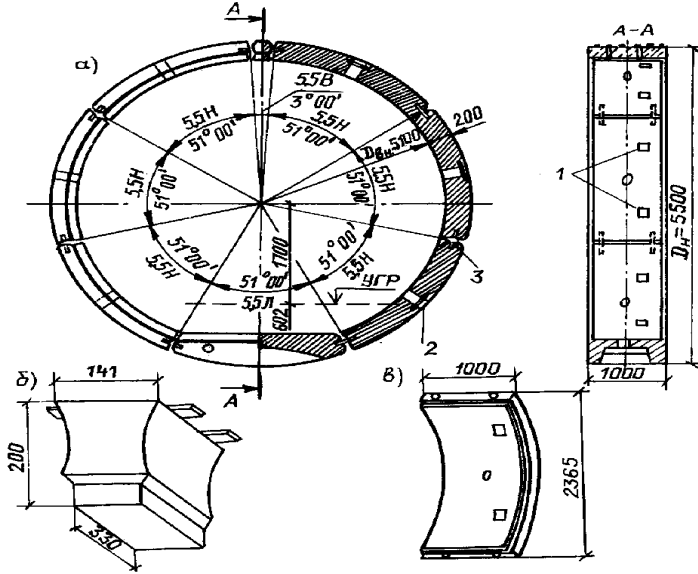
Сборная железобетонная обделка из блоков сплошного сечения:
